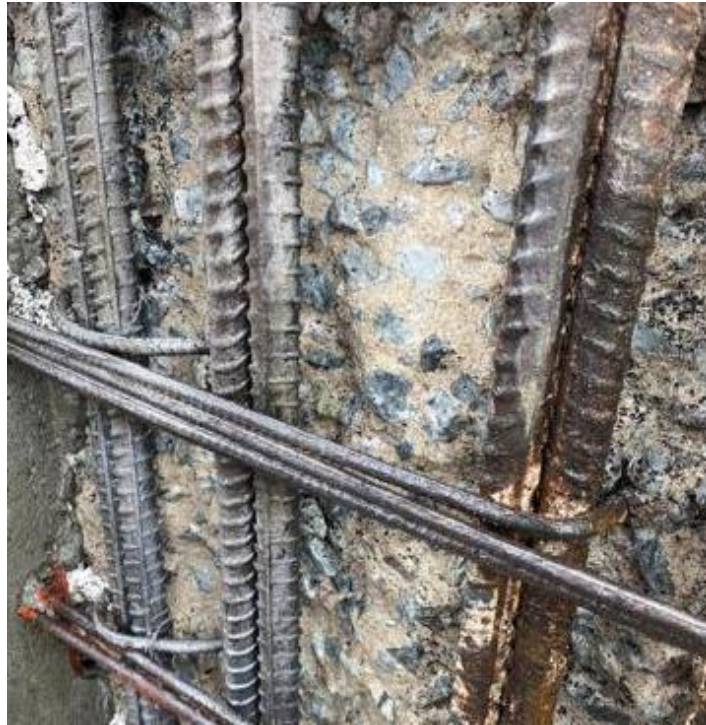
Limpeza das armaduras de forma mecanizada, utilizando lixadeira e furadeira com escovas metálicas
